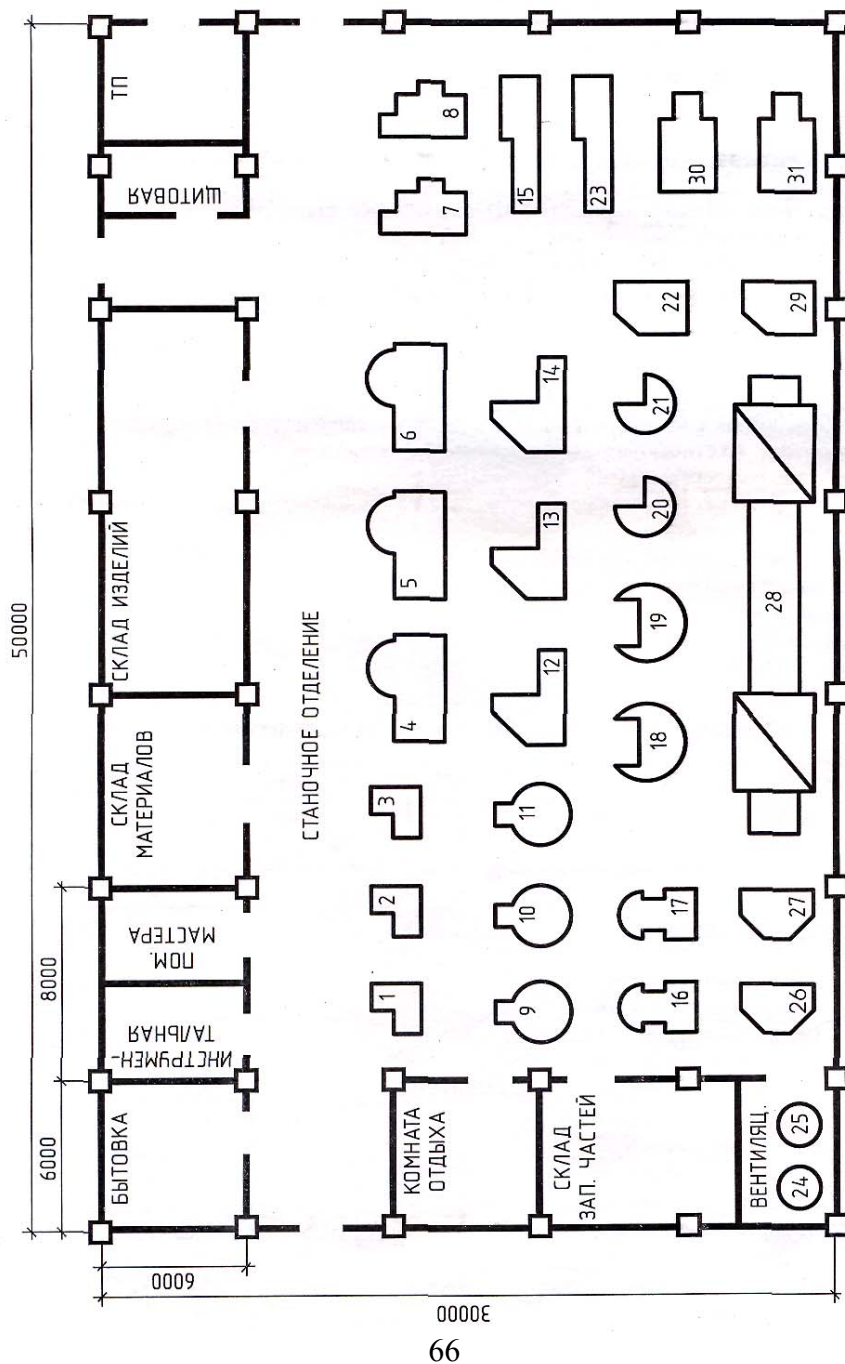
План расположения ЭО участка механосборочного цеха
